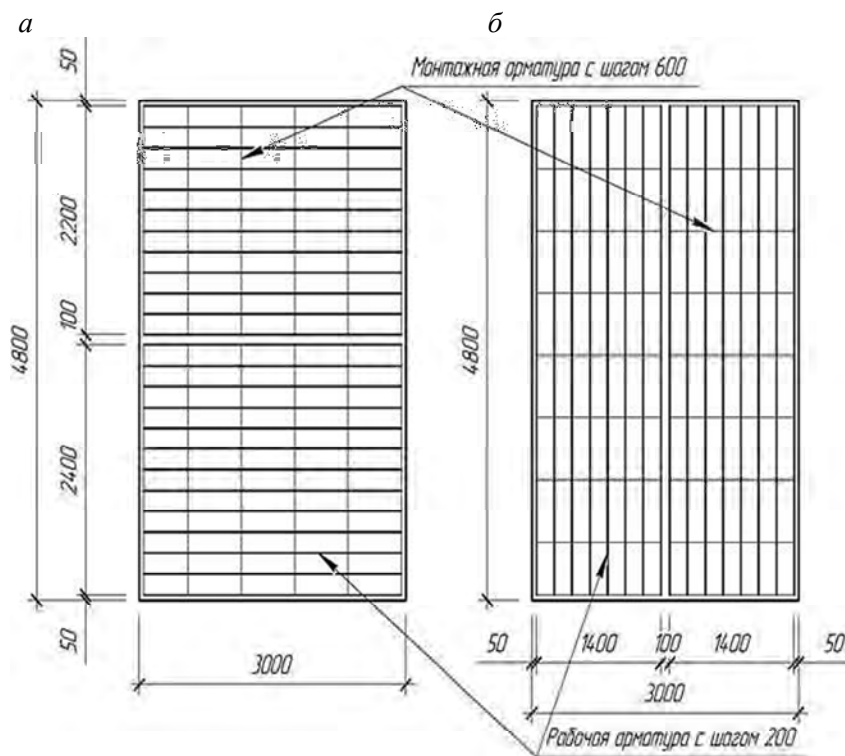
Схема армирования фундамента сварными унифицированными сетками:
